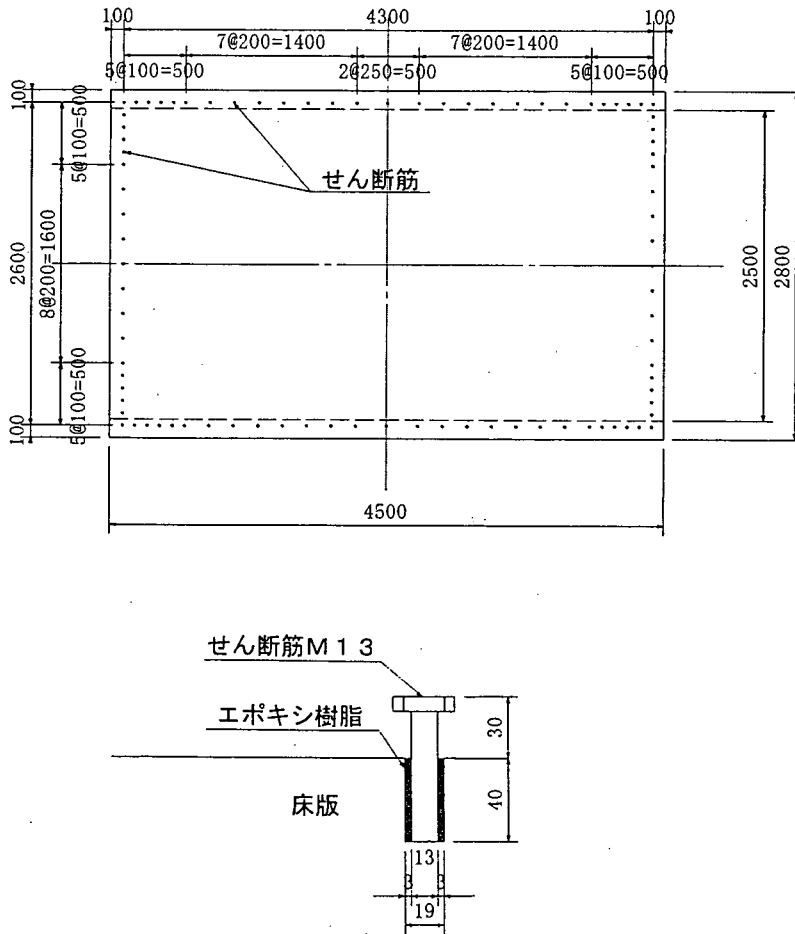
RC39+上面-2 供試体のせん断筋配置図 (単位: mm)
